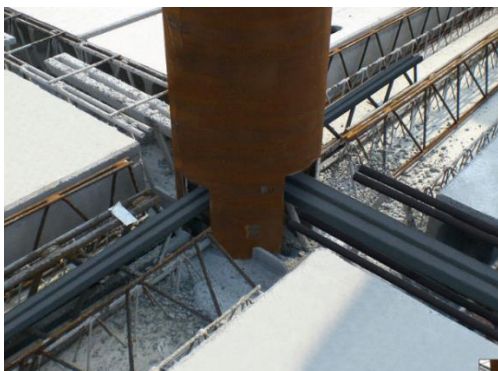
PORMENOR DA LIGAÇÃO COLUNA-VIGA
